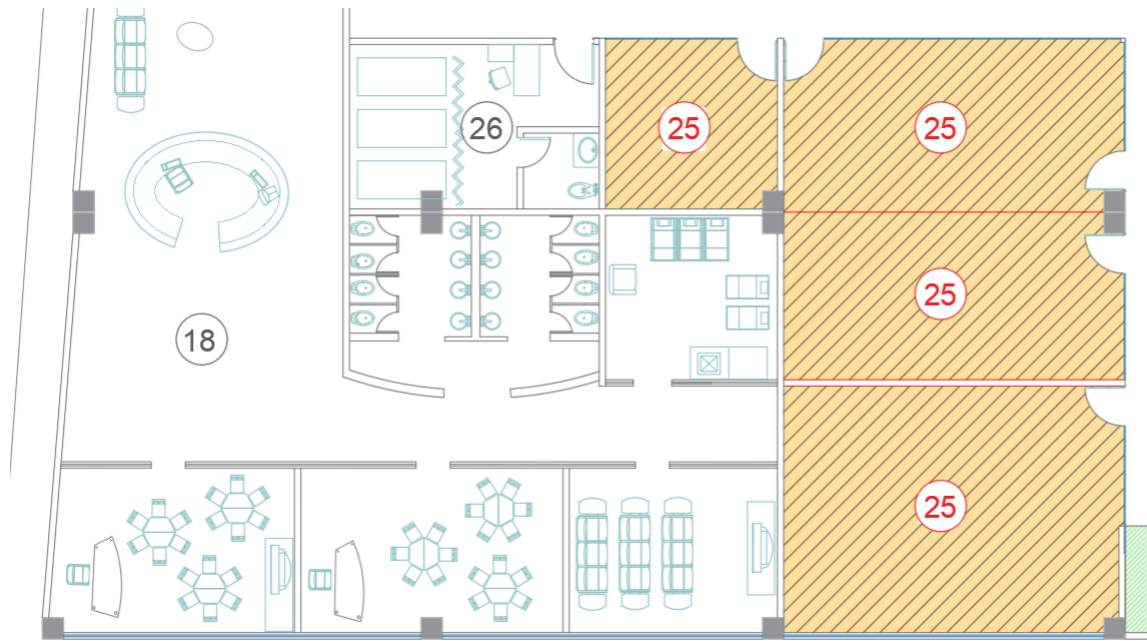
propuesta de zonificación y distribución de locales de galería de arte, joyería y artesanía planta alta
